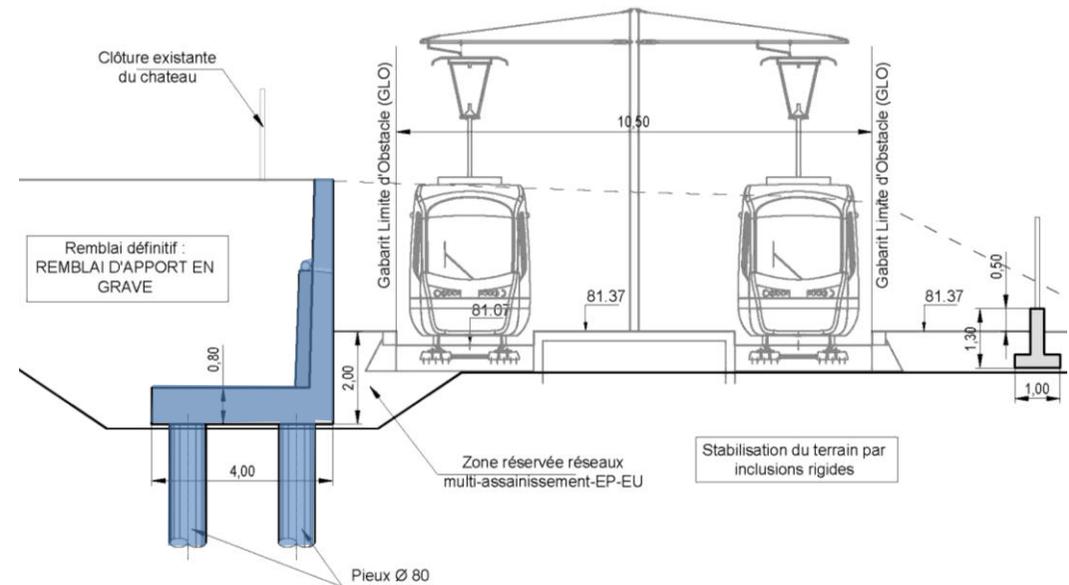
Coupe X – représentation du mur haut sur fondations profondes
